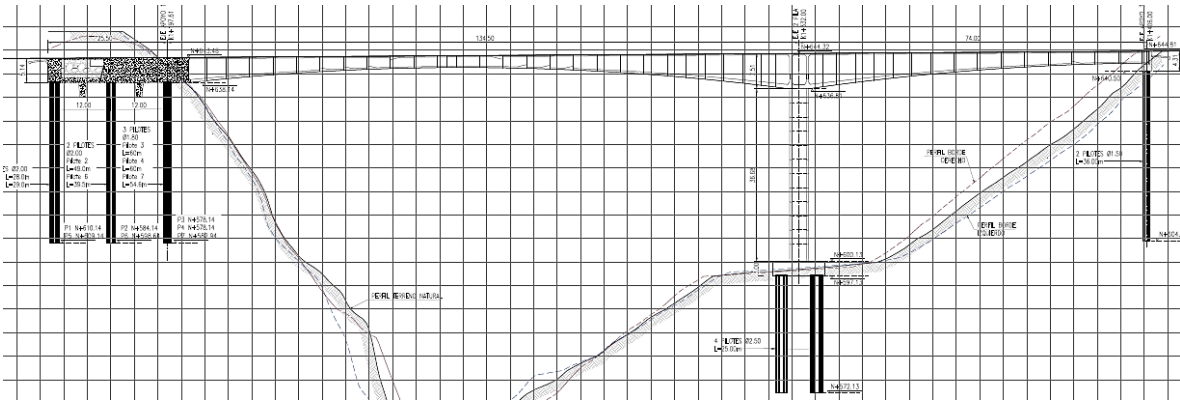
Perfil puente caso de estudio 1. Tomado del plano planta perfil del puente.
